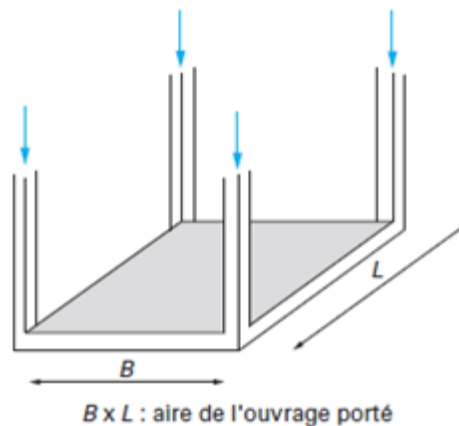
fondation de type radiers selon le DTU 13.12(1988)
